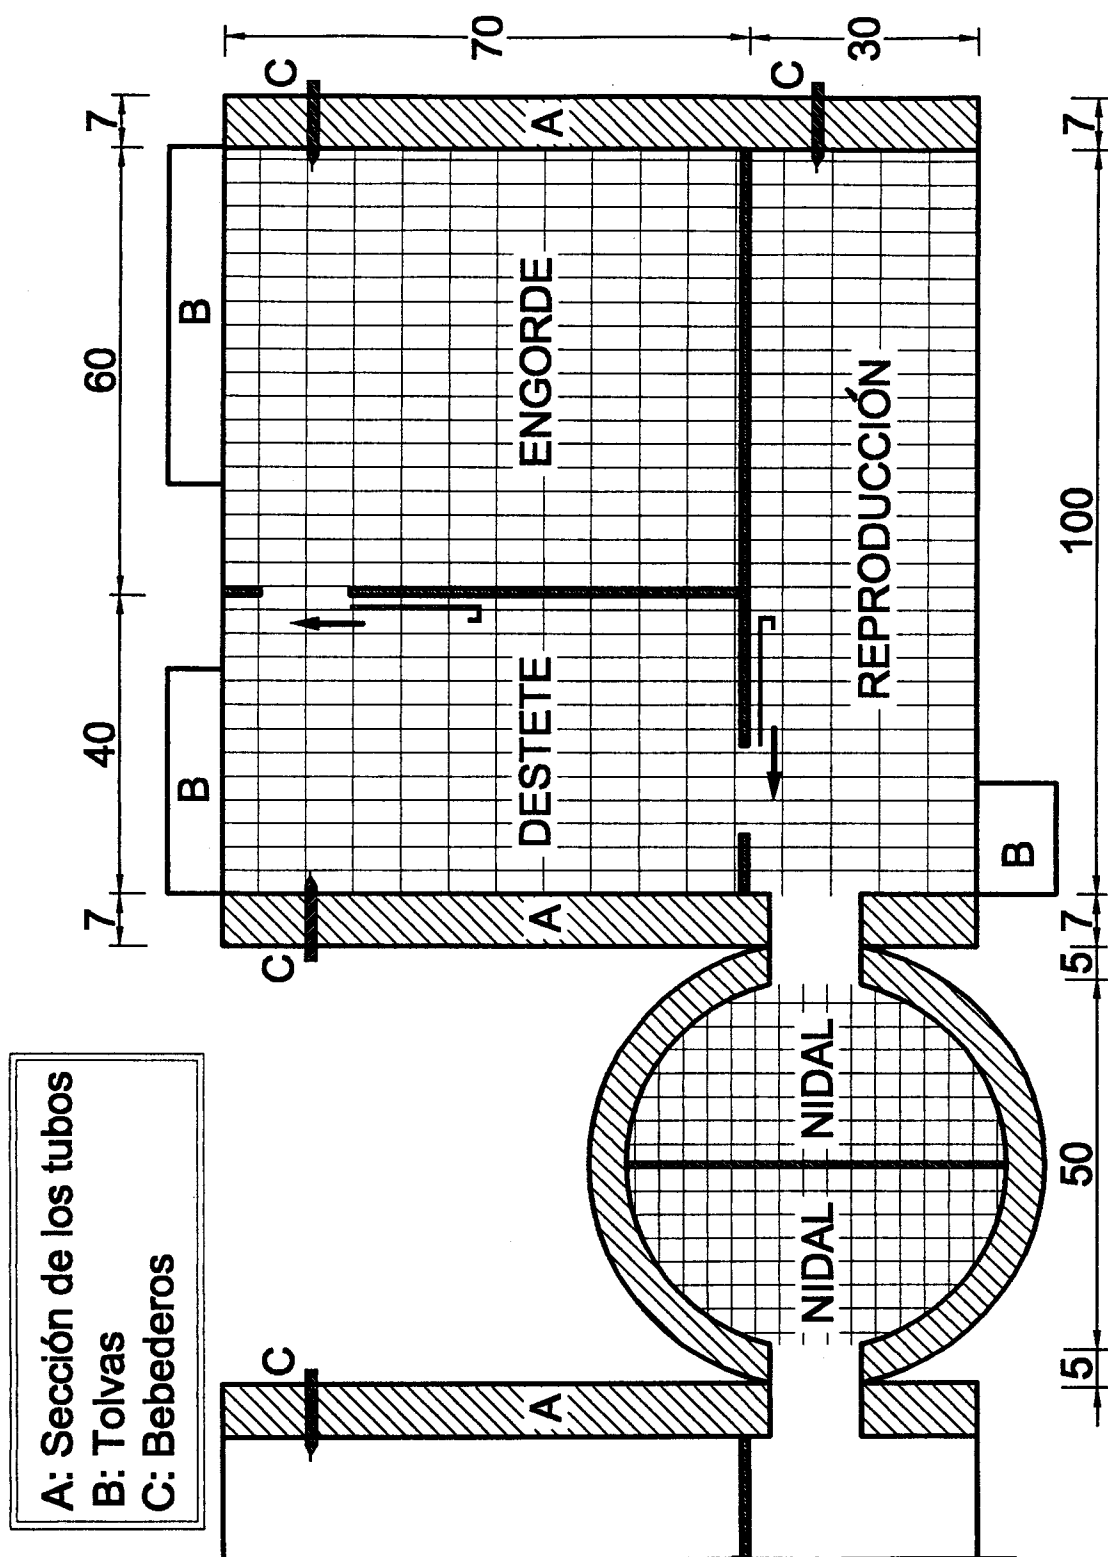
Planta de la estructura de un sistema de reproducción y engorde en tubo de cemento prefabricado
